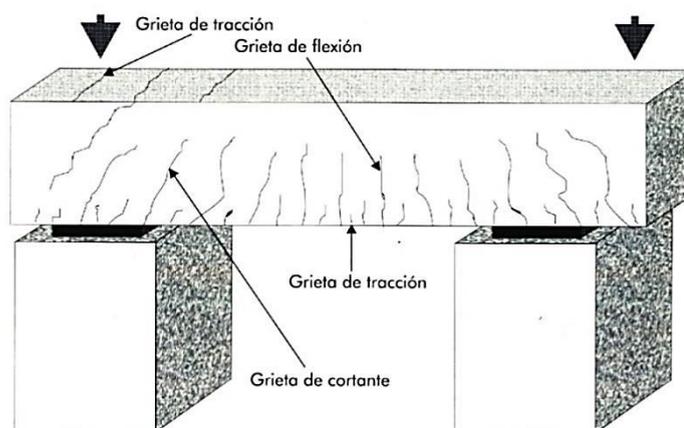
29 GRIETAS POR CORTANTE, FLEXIÓN Y TRACCIÓN DE VIGAS DE CONCRETO ARMADO.
